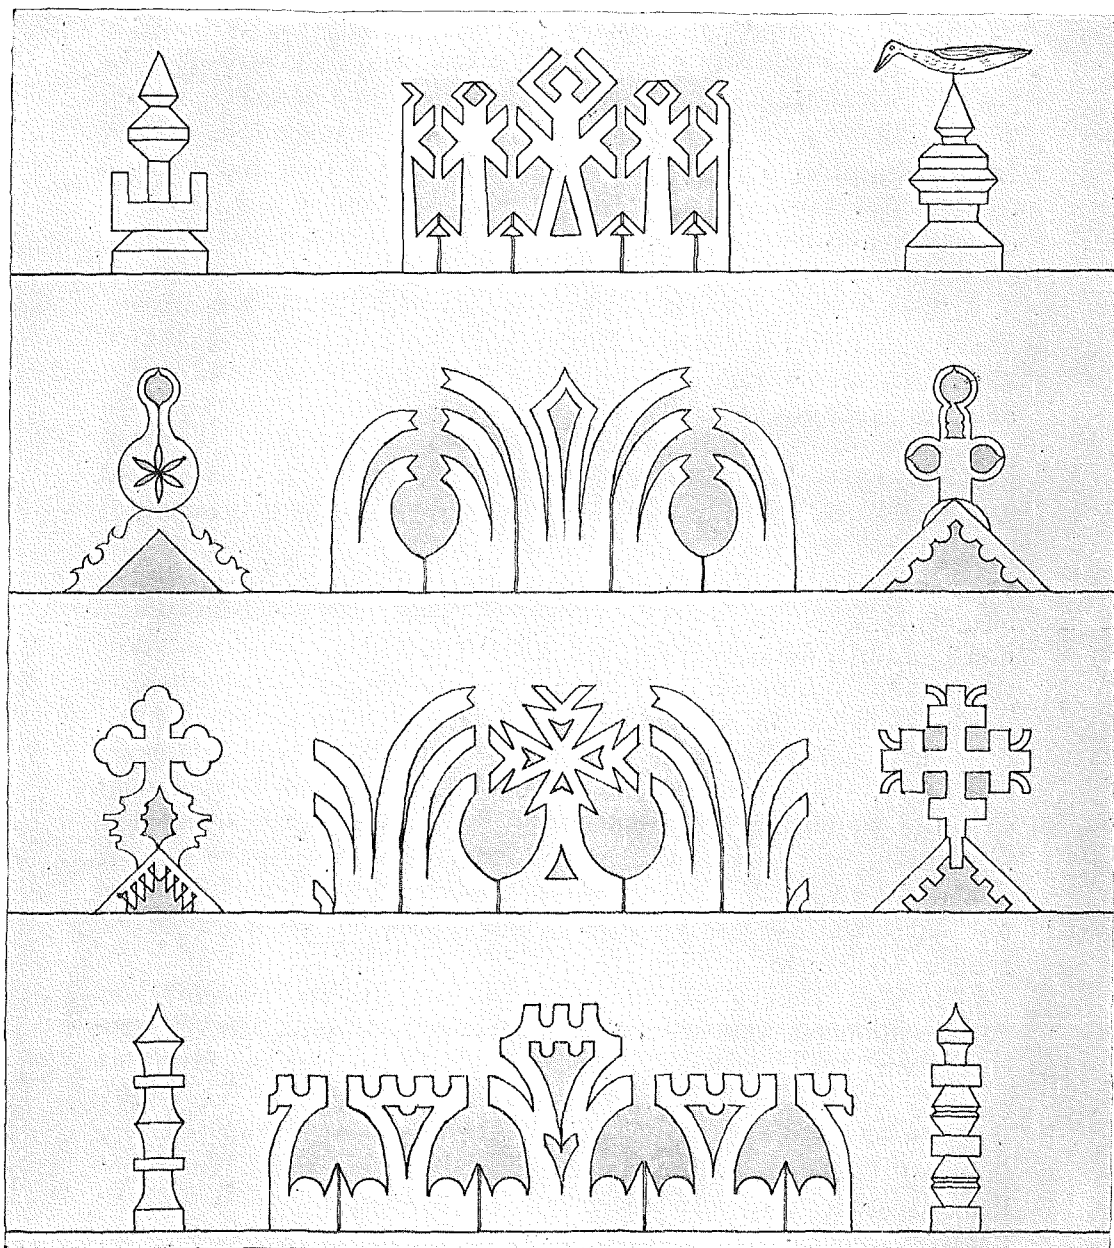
Firstschindelverzierungen und Ecksäulchen am Bauernhause.
